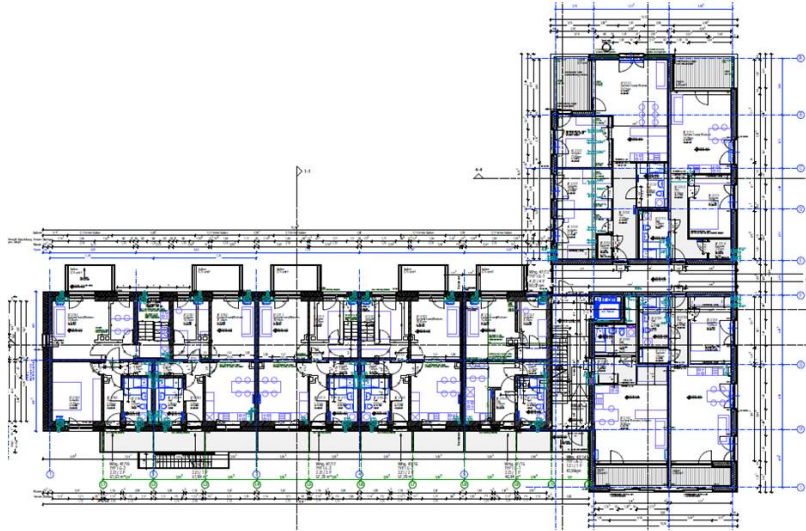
Fachhochschule Kuchl, Grundriss, Detailschnitt
